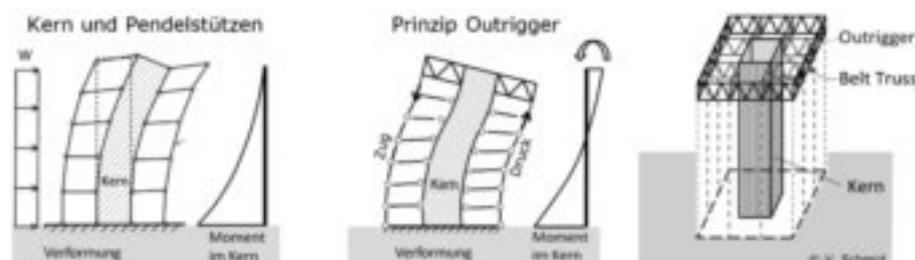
Aussteifung mit Kern (links); Kern und Outrigger (mitte); Outrigger und Belt Truss (rechts)
